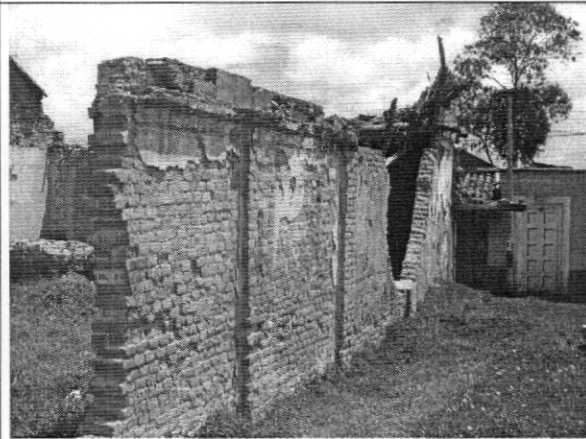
Muro medianero sin elementos de confinamiento y colapso parcial
